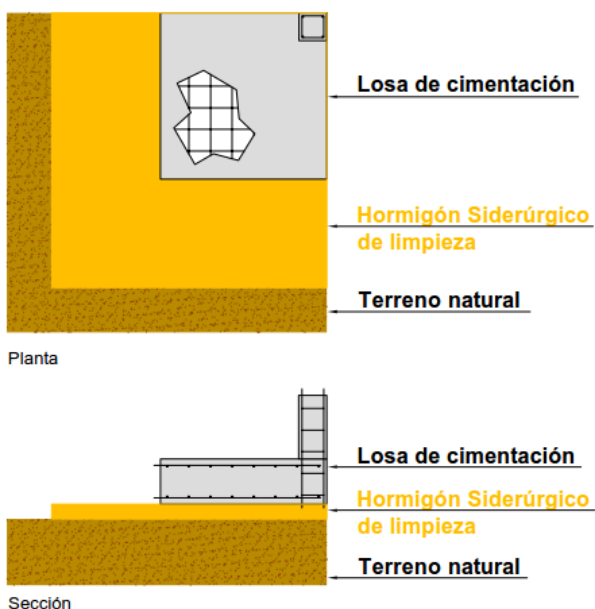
HORMIGÓN DE LIMPIEZA BAJO ZAPATA.
